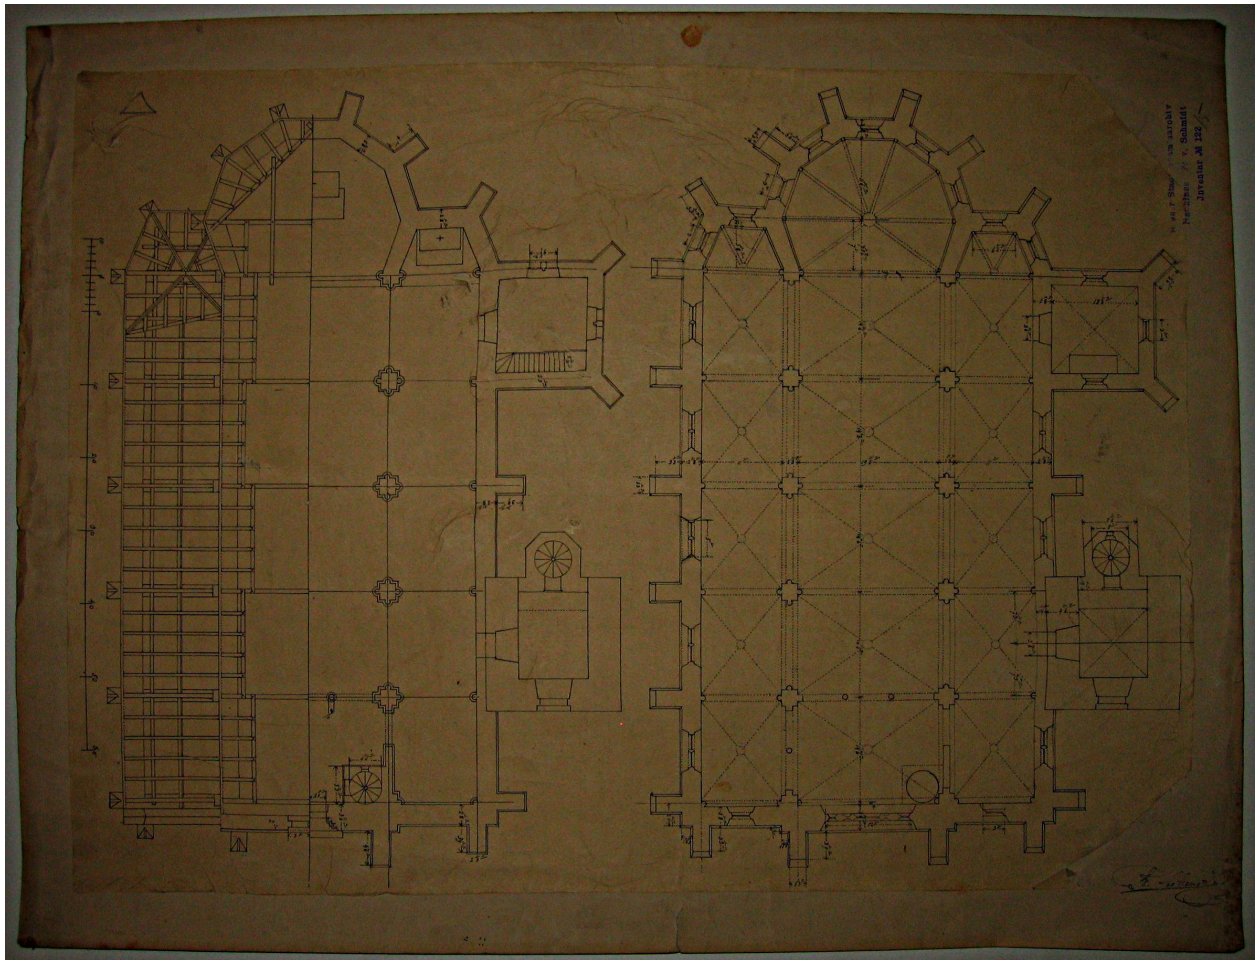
WM, Inv.-Nr. 157.122/1 Grundriss
